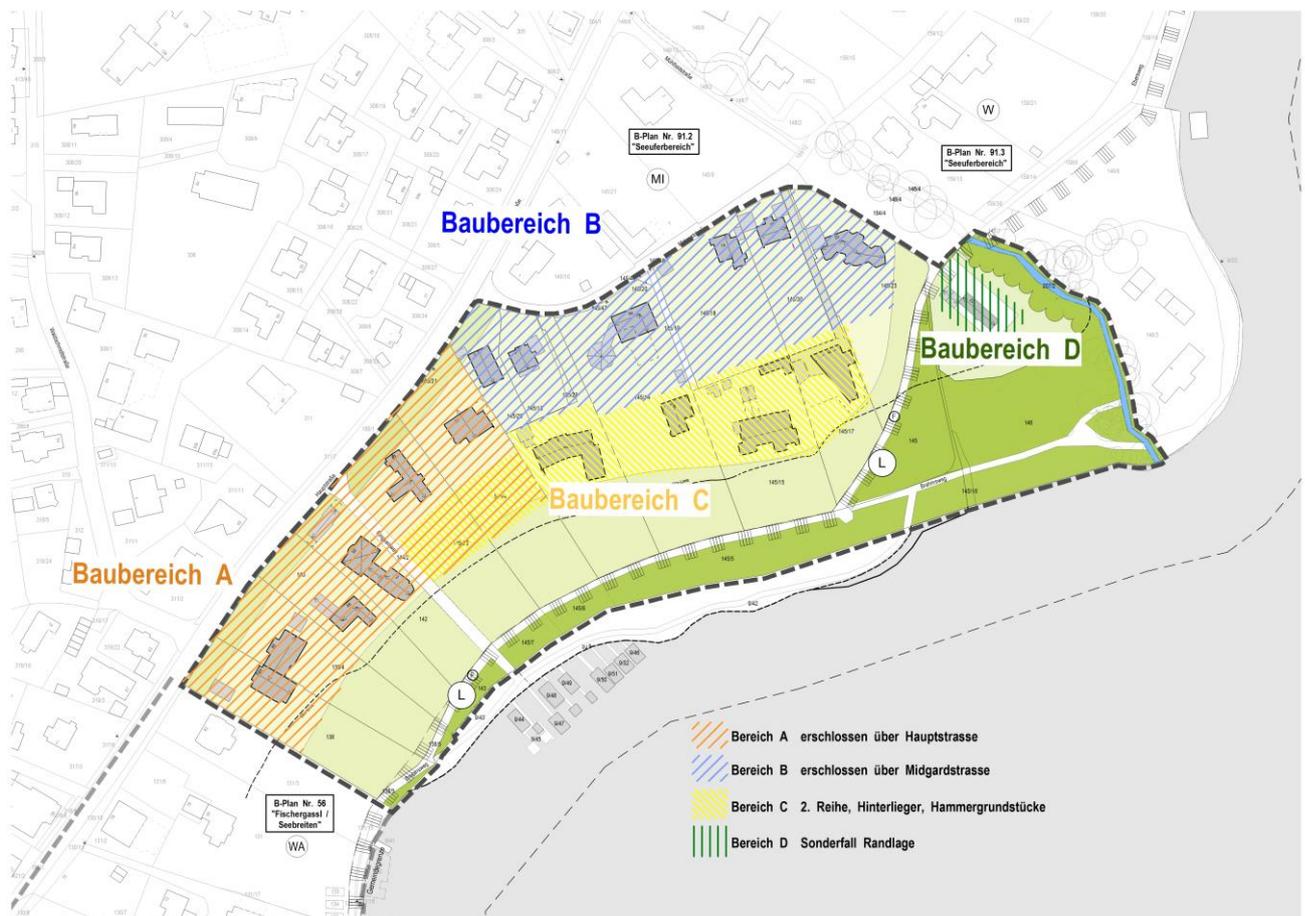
Gliederung des bebauten Planungsgebietes in vier unterschiedliche Baubereiche
